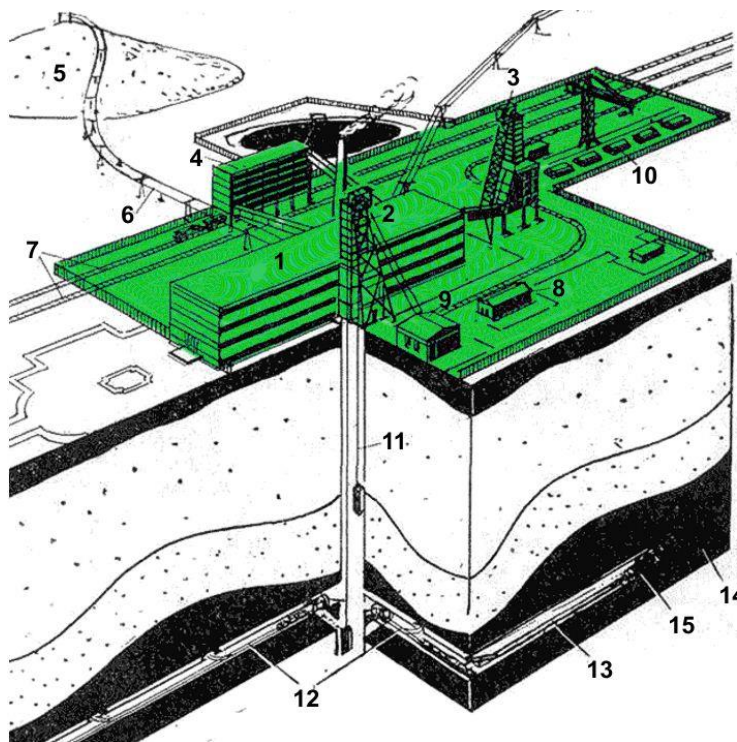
Схема угольной шахты. 1-надшахтное здание; 2-копер главного ствола; 3-копер вспомогательного ствола; 4-бункер для загрузки угля; 5-террикон; 6-подвесная дорога; 7-железнодорожные пути; 8-здание вентилятора; 9-здание подъемной машины; 10-склад; 11-главный ствол; 12-откаточные выработки; 13-конвейерный штрек; 14-пласт угля; 15-забой.
